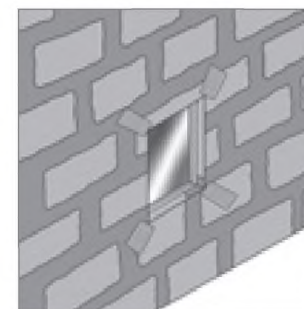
Армирование облицовки в углах оконных и дверных проемов
